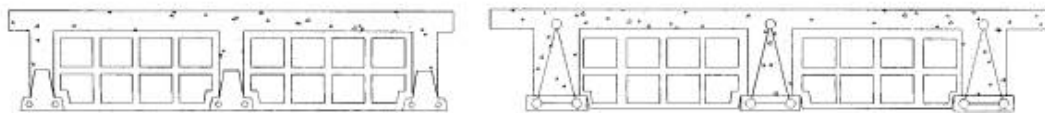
Lajes com vigotas pré-moldadas (PEREIRA, 2001)
